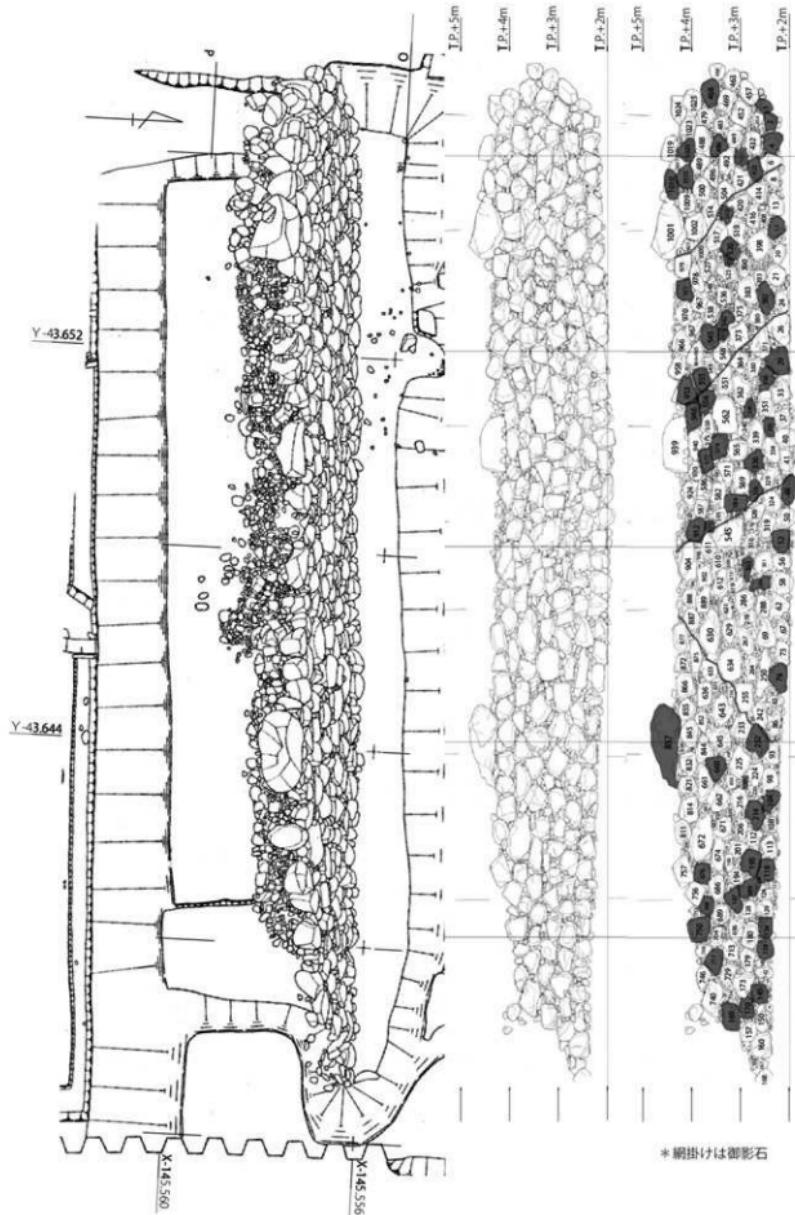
OSJ90-1区 三ノ丸石垣の平面図、正面図 根石部分を含む(1/100)
